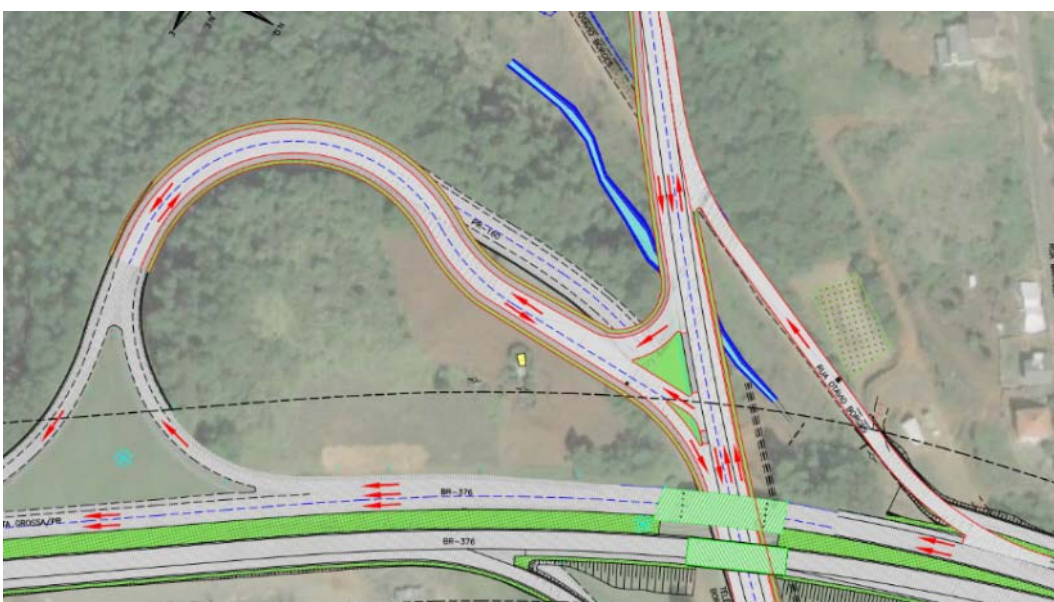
Traçado da interseção da PR-160 com PR-160 - Proposta 04.
